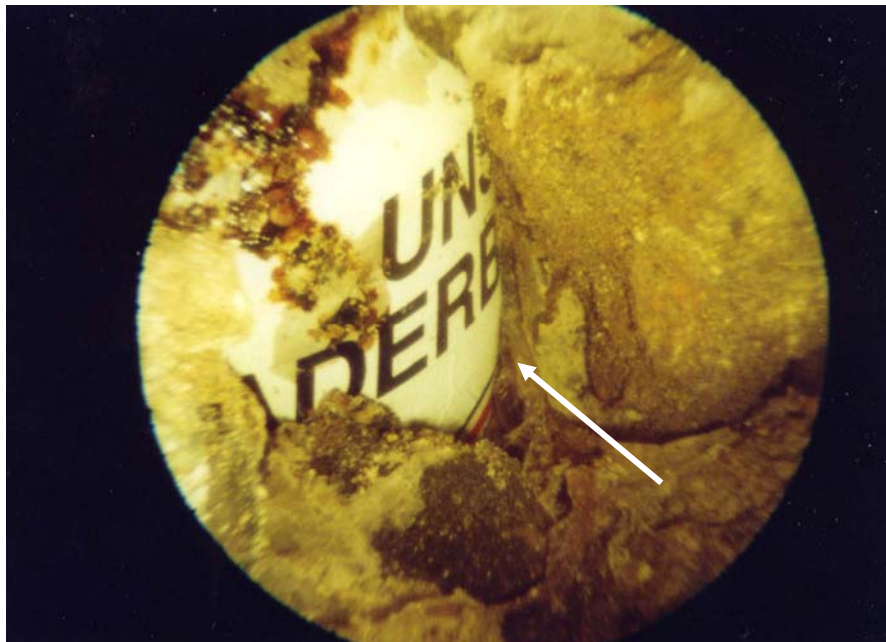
Vom Myzel des Echten Hausschwamms (Pfeil) durchwachsender Bauschutt mit Bierdose.
